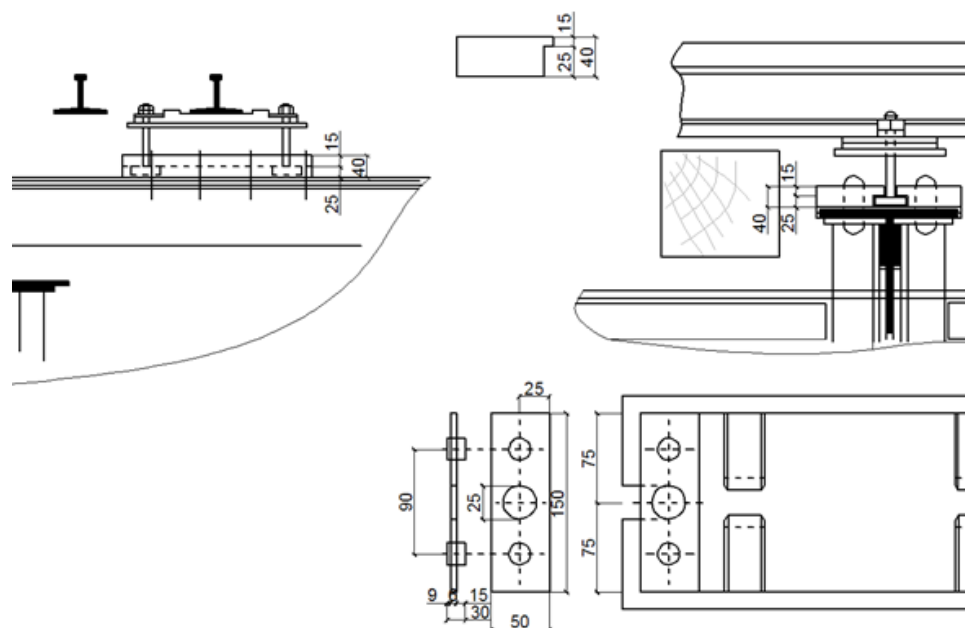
Прикрепление сваркой центрирующей планки к продольной балке
